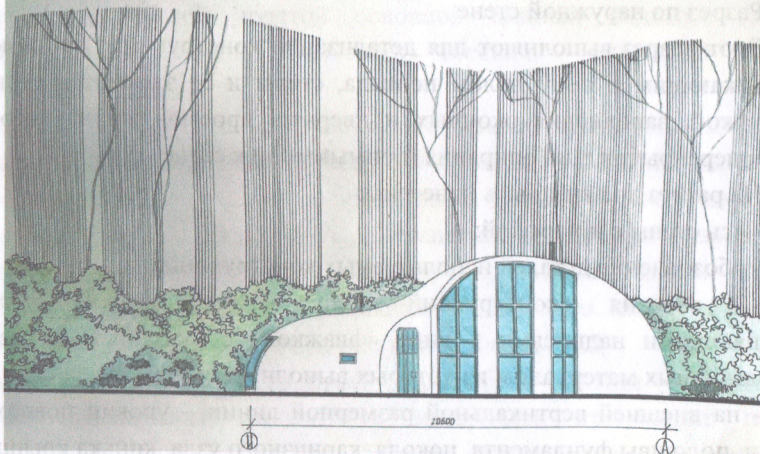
Фасады жилого дома (фрагмент студенческого проекта кафедры «ДАС»)
